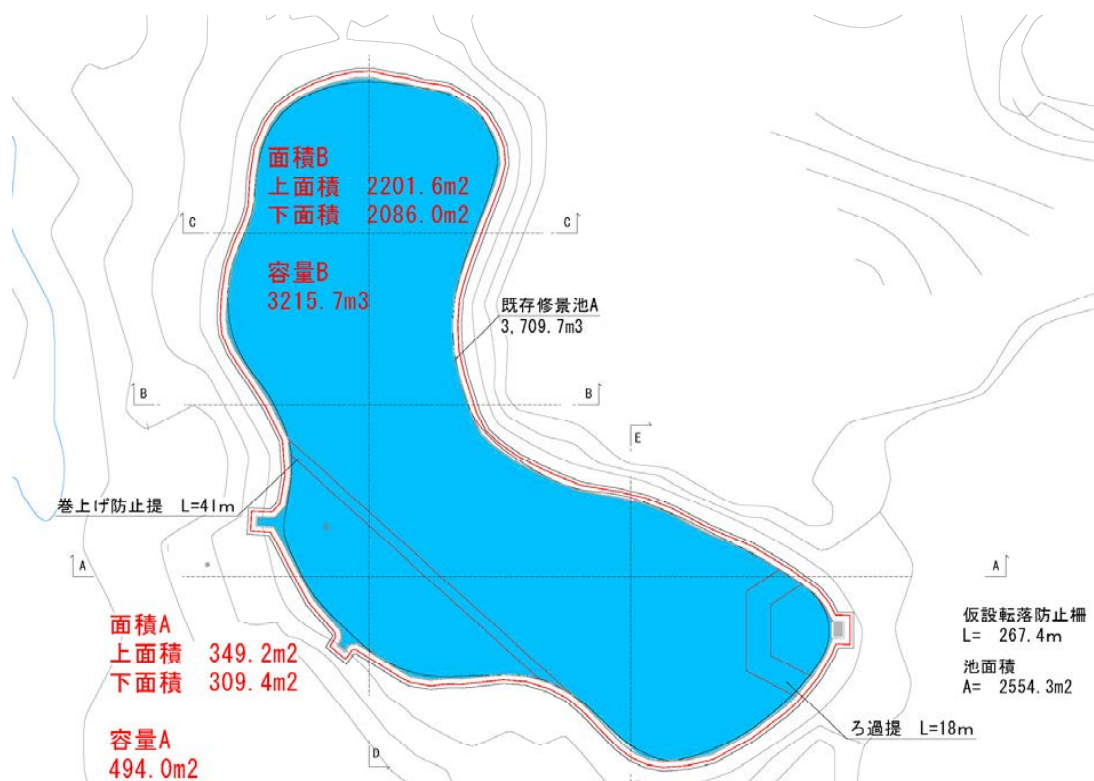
2号沈砂池平面図（既存修景池を利用）
